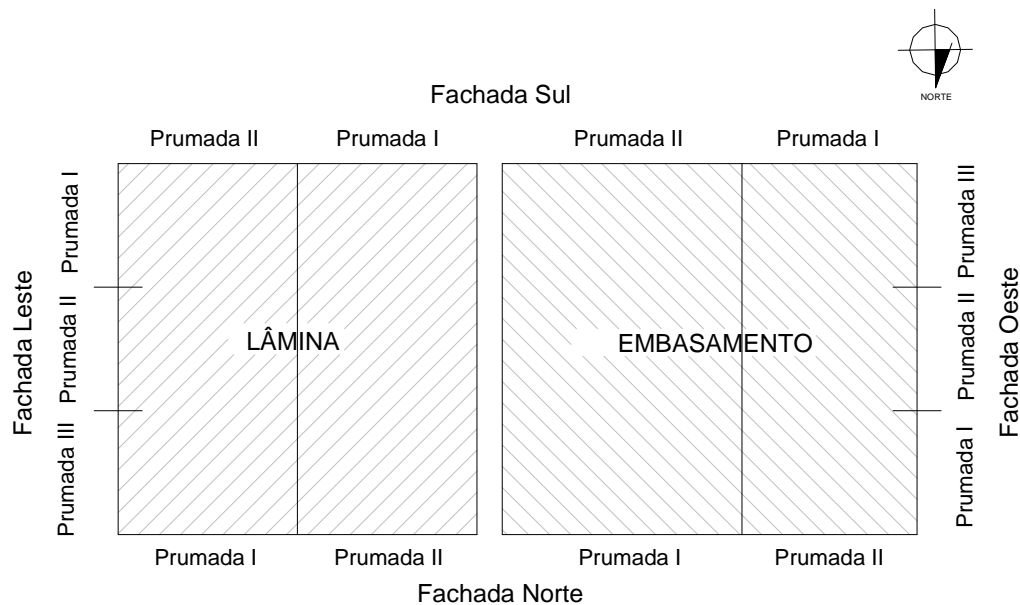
Ilustração esquemática da orientação das fachadas do edifício E.
